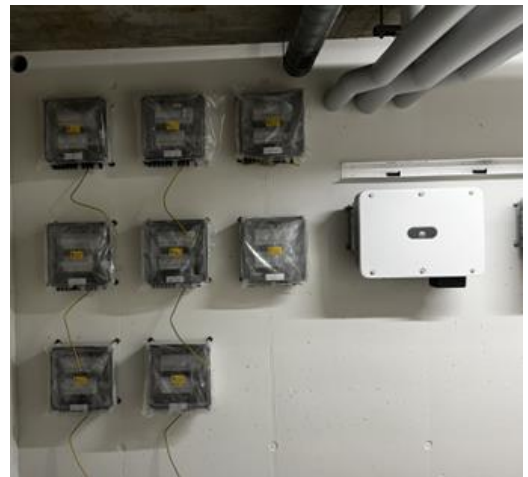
PV Fassaden - GAK vor Gebäudeeintritt
